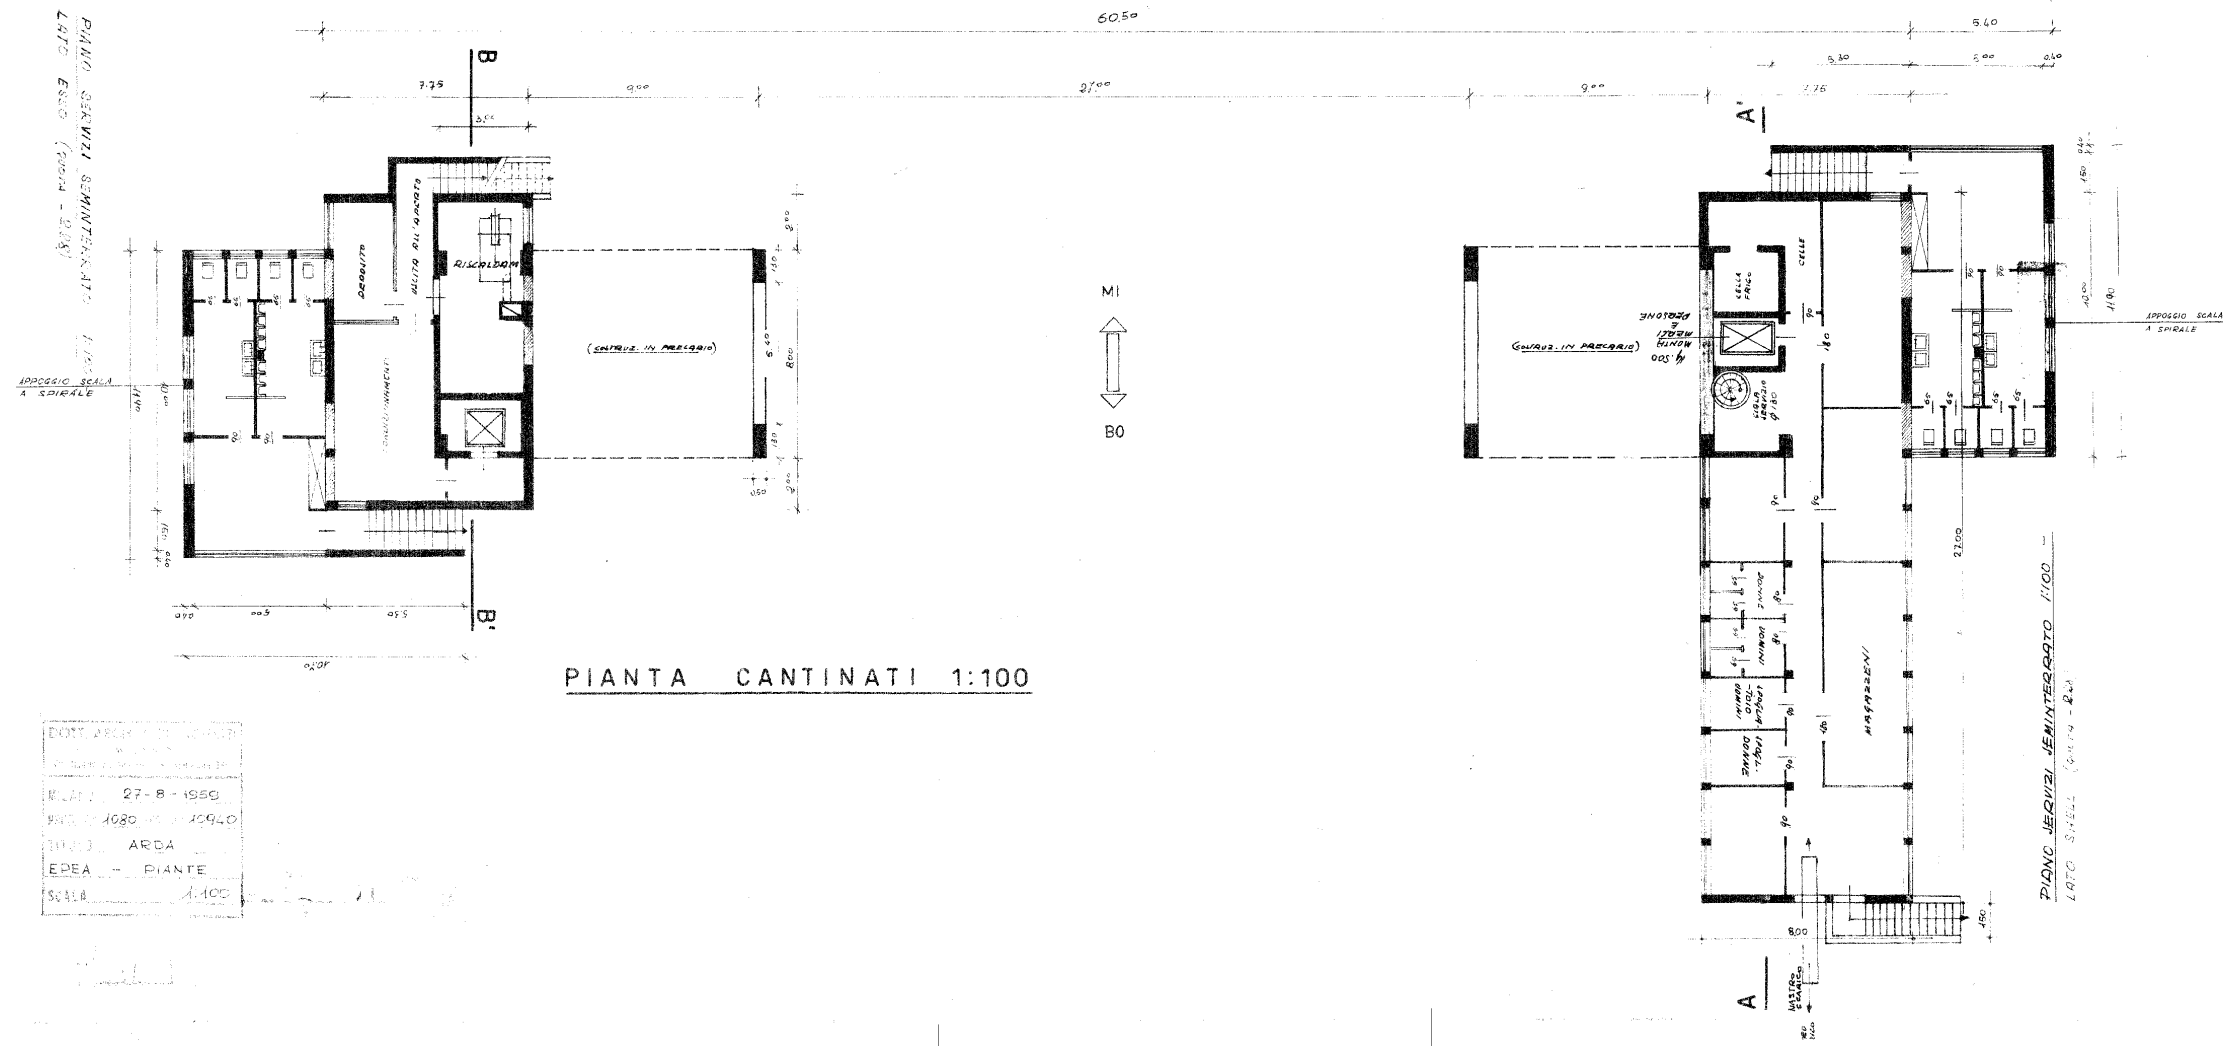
Pianta piano interrato dell'autogrill Pavesi di Fiorenzuola (AAB)
